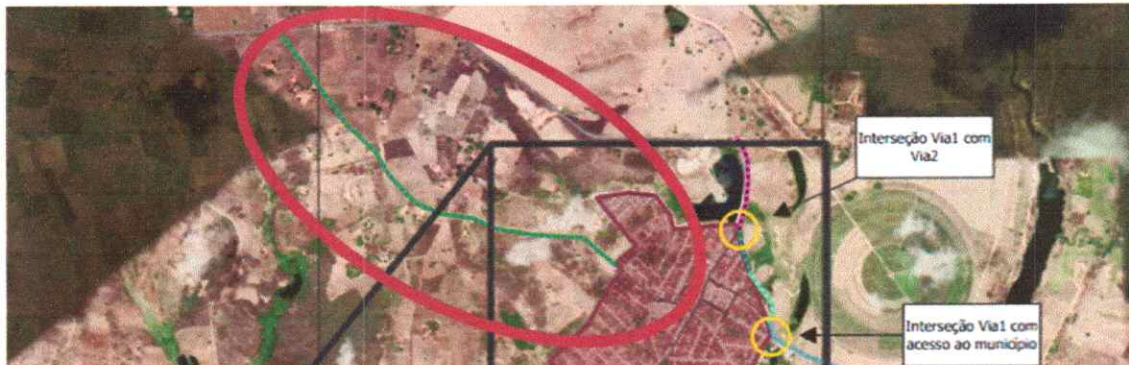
Via 03 – São Miguel de Taipu / PB-042 (Acesso Oeste) – Planta
